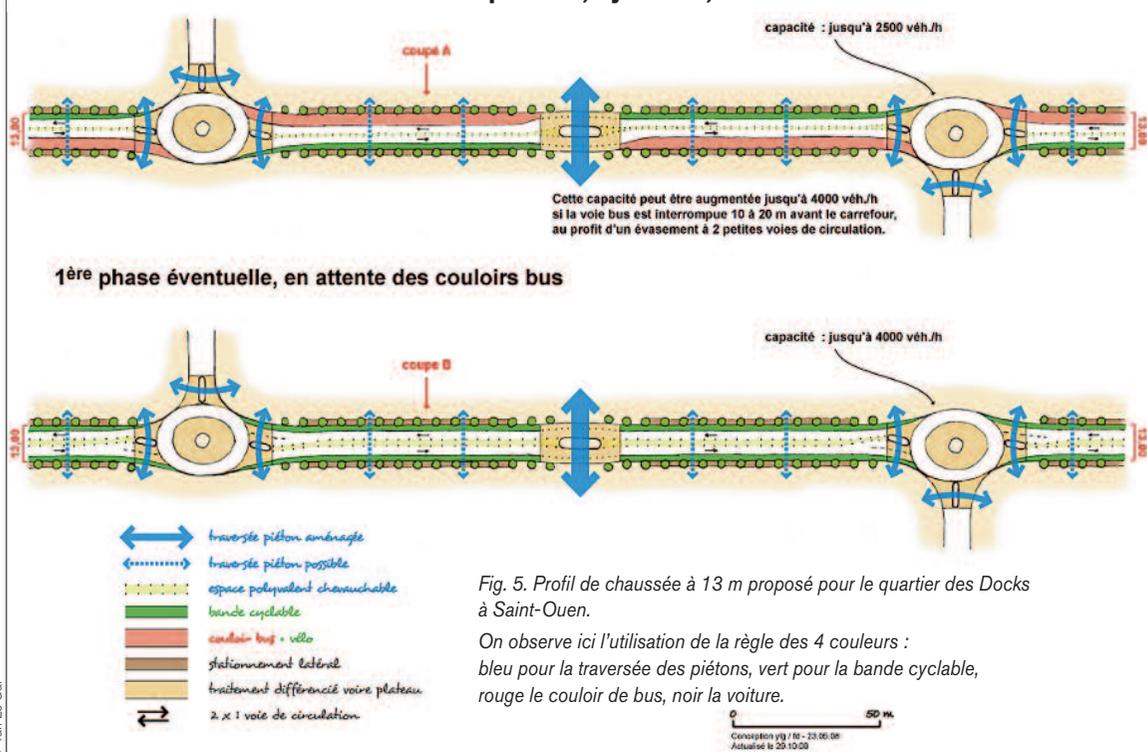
Profil de chaussée à 13 m proposé pour le quartier des Docks à Saint-Ouen.
